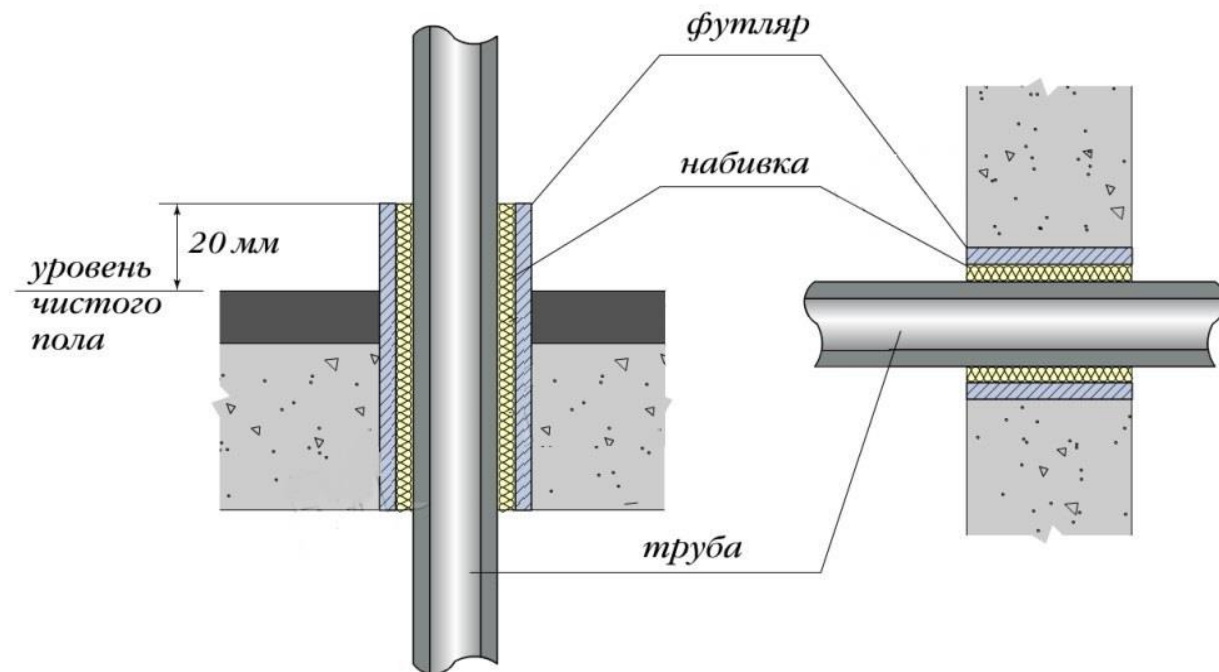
Схема прокладки трубопроводов в строительных конструкциях
